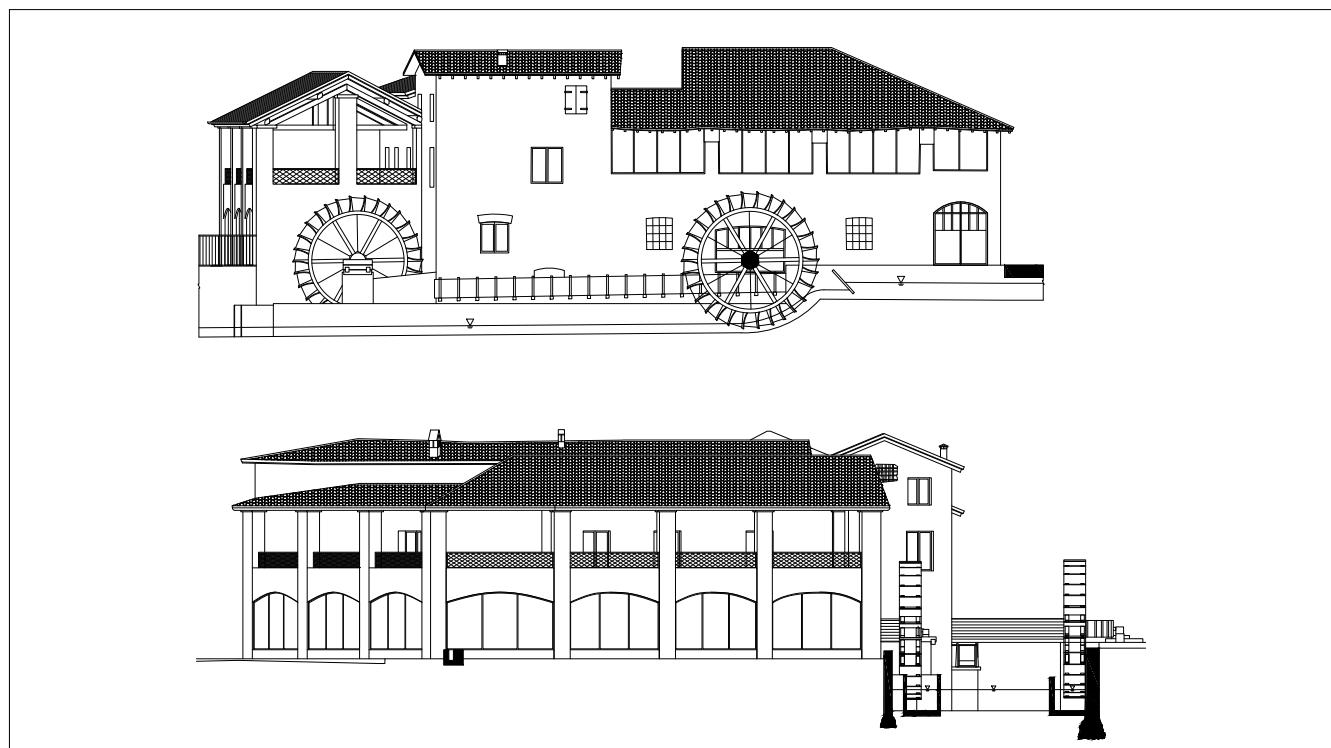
Mulino di Nove. Prospetto est e prospetto sud.
